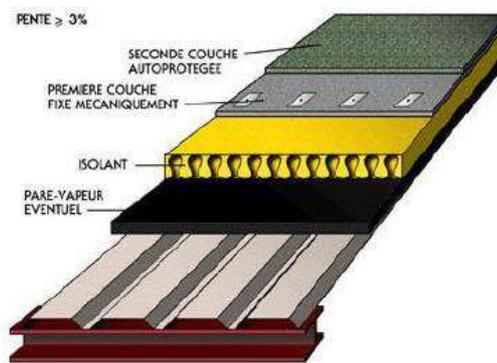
Exemple de couverture en acier avec isolation et étanchéité.
